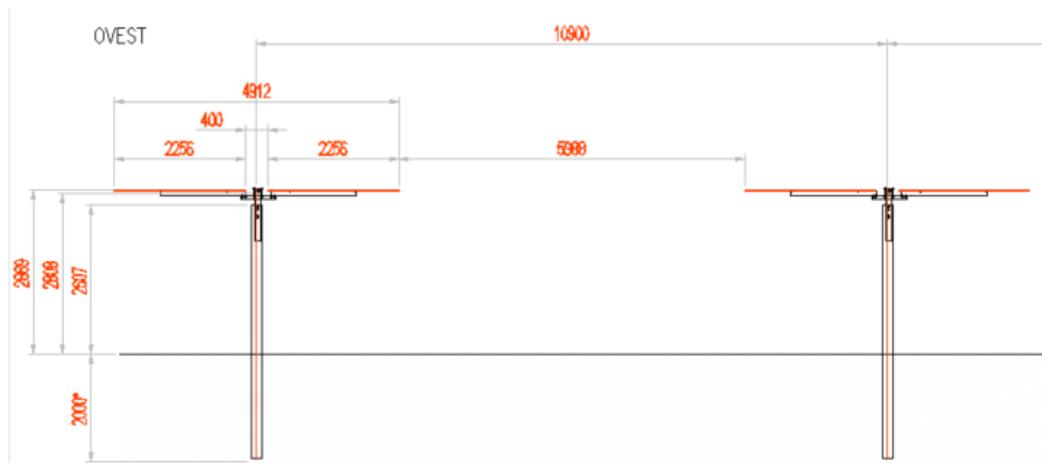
Particolare strutture di sostegno moduli – sezione trasversale
